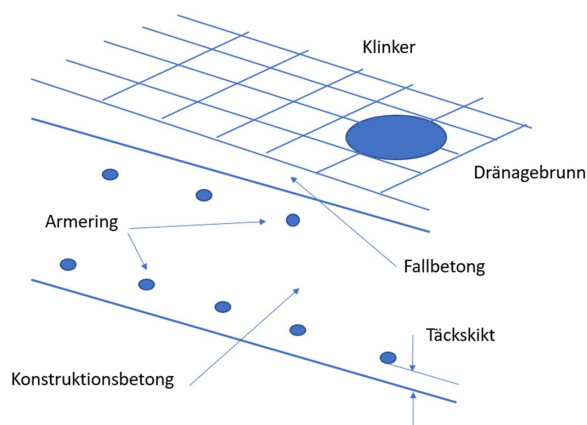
Principskiss – Bjälklag med armering, konstruktions- och fall betong.
